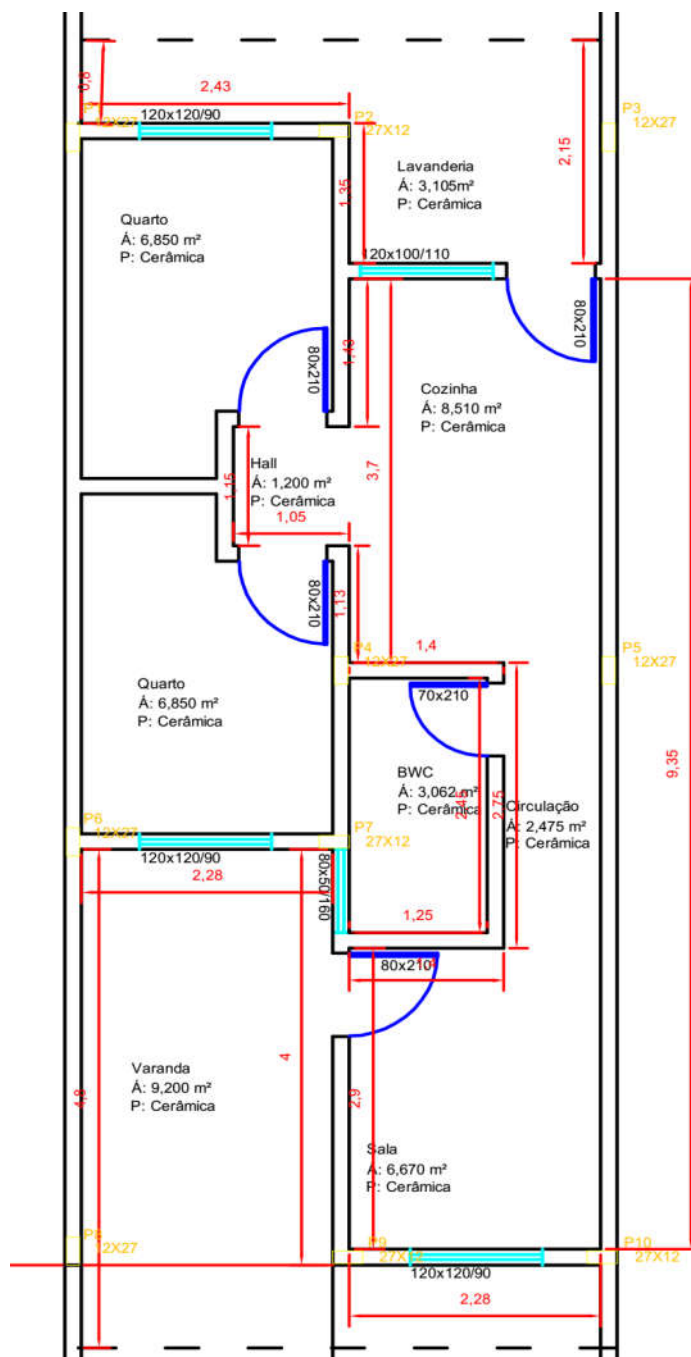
Planta baixa da construção convencional. Fonte: o autor (2016).
